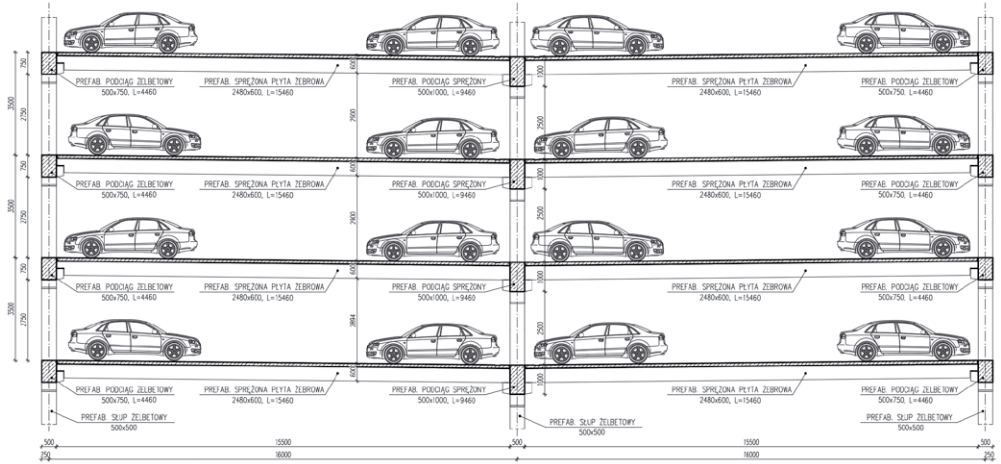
Przekrój poprzeczny powtarzalnego układu konstrukcji stropów parkingu wielopoziomowego
